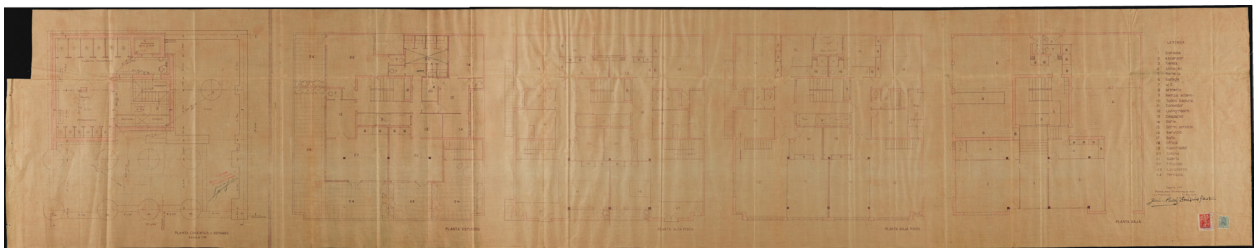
Plano de plantas del primer proyecto de Sert. Expediente Fo-3756/1929. 1929. Plano sin numerar. Arxiu Contemporani de Barcelona.
